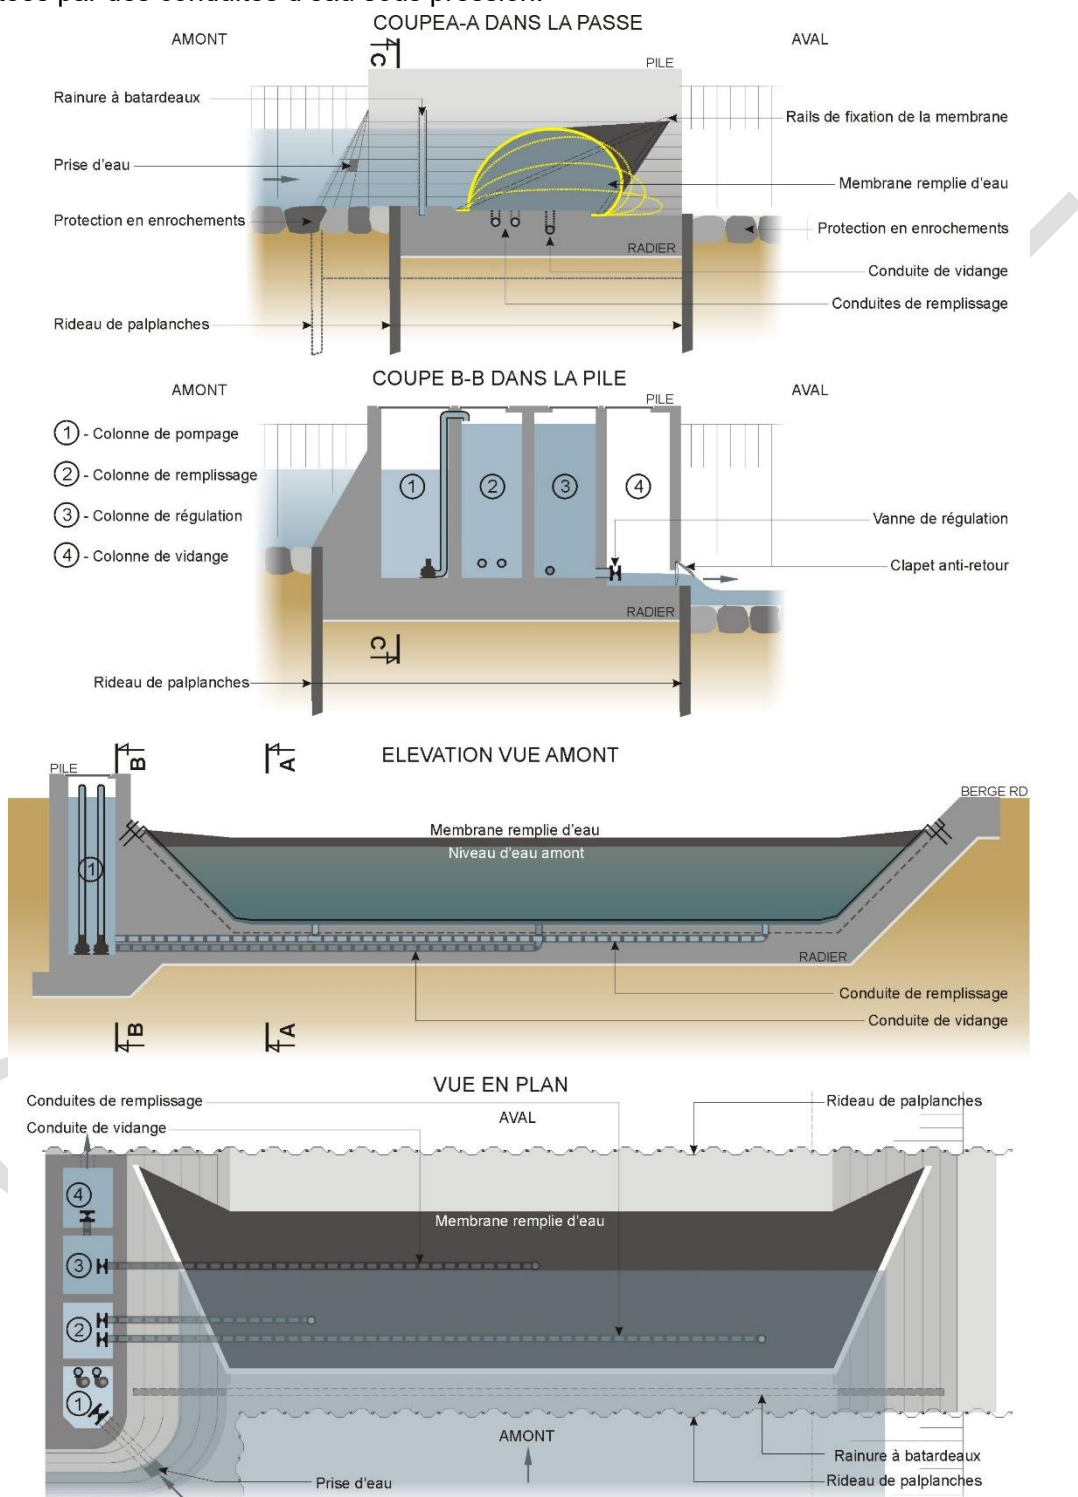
Principe constructif d'un barrage gonflable à l'eau © BRLingénierie
